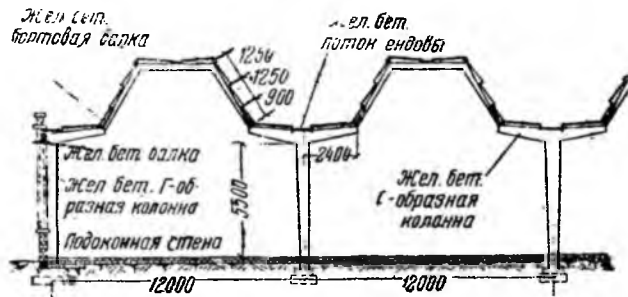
Покрытие с железобетонными Т-образными колоннами.
